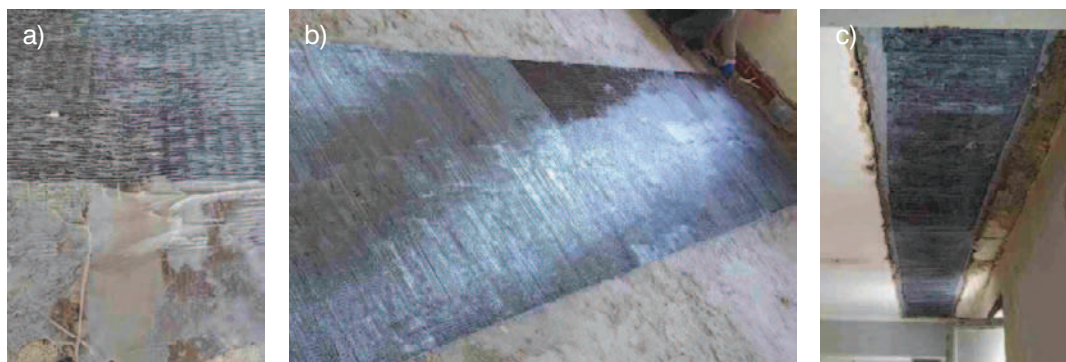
Etap I: a) widok przygotowanej powierzchni, b) gruntowanie
